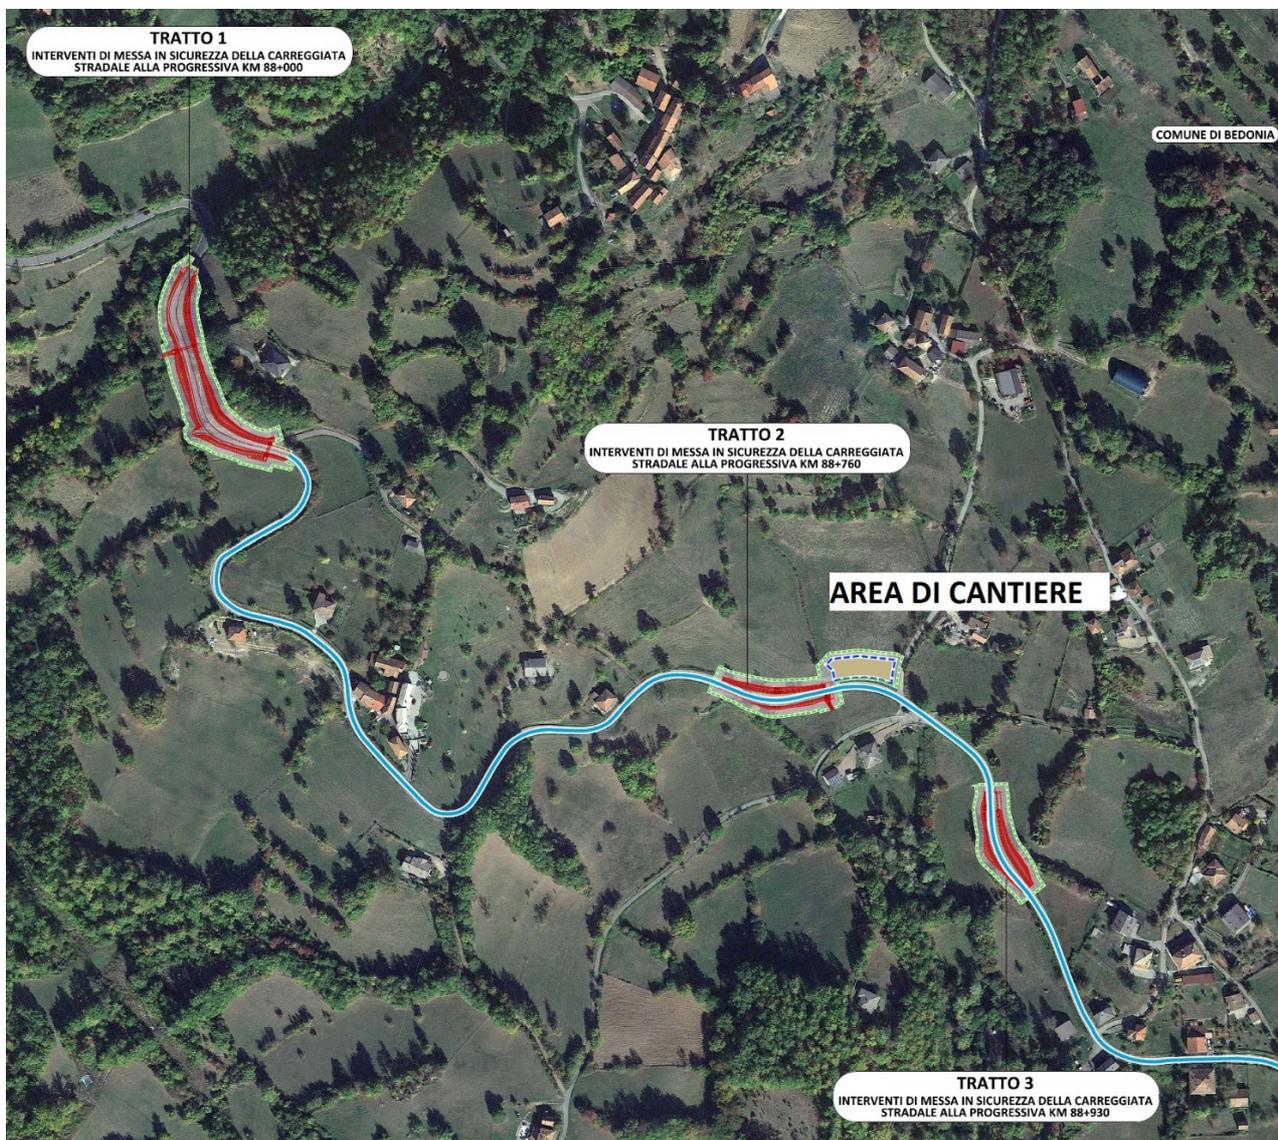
UBICAZIONE DEL CANTIERE LOGISTICO (ESTRATTO DALL'ELAB. PD.04.03)
